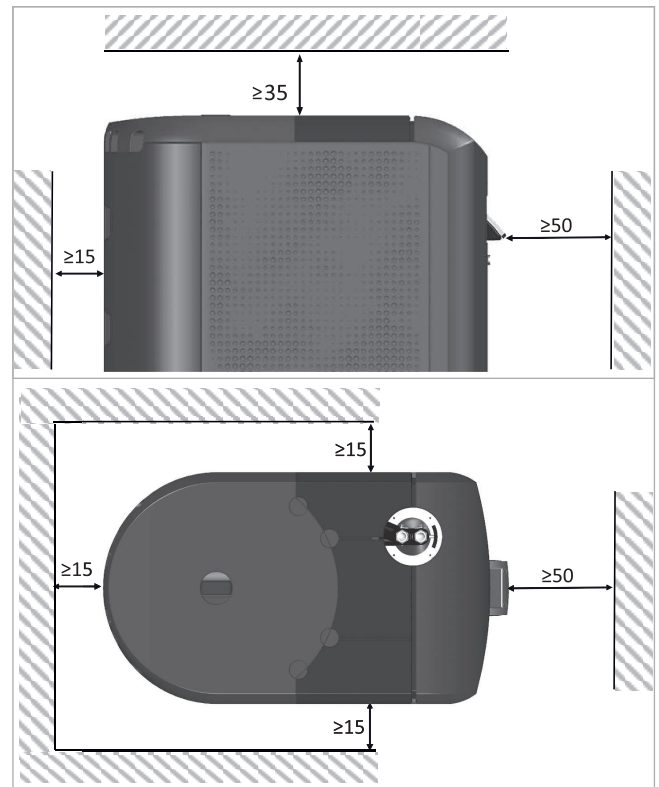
Mindestabstände SolvisBen Solo (alle Maße in cm)
